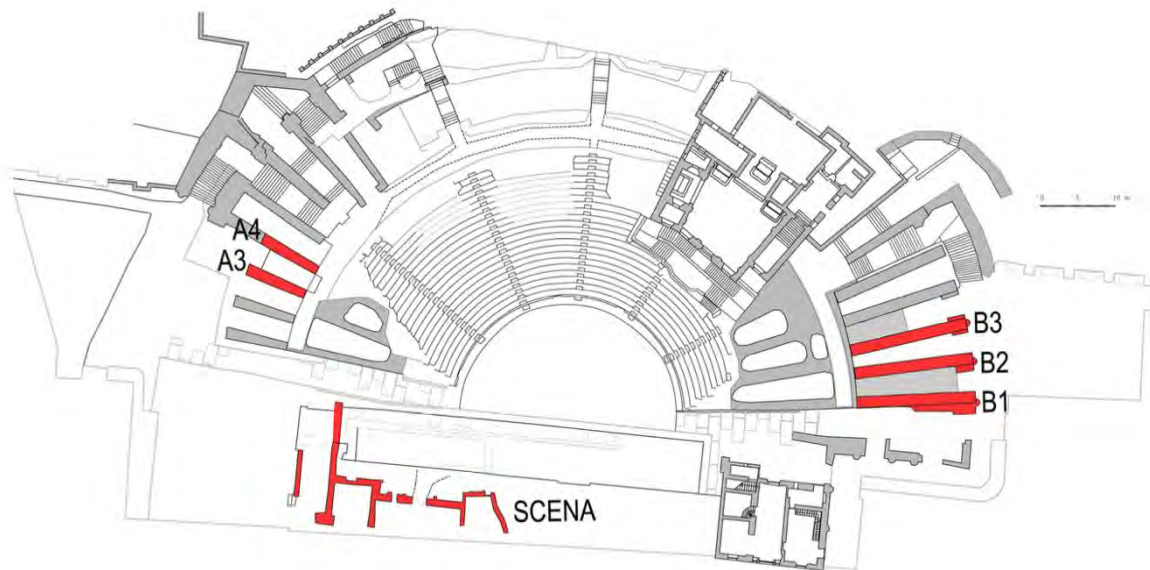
Pianta con indicazione degli elementi oggetto di studio
